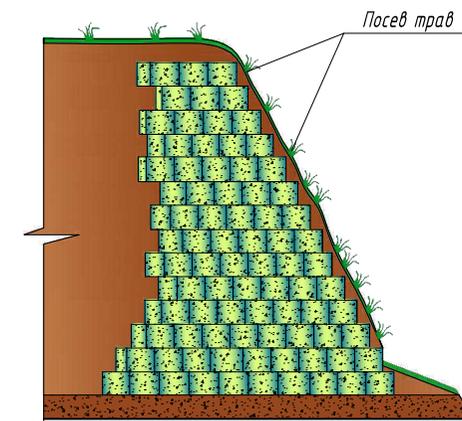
Армогрунтовая подпорная стенка с растительным грунтом
